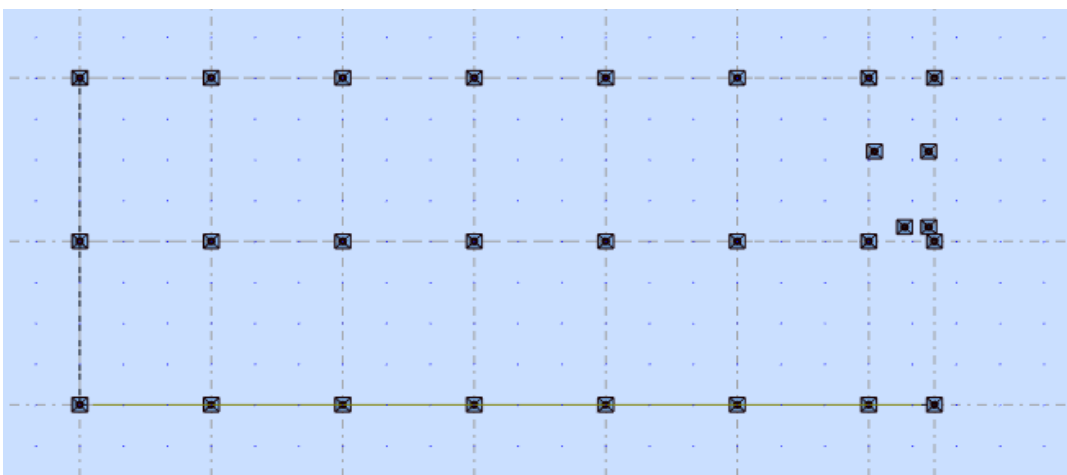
Vue en plan du plancher niveau : 0,0 m
